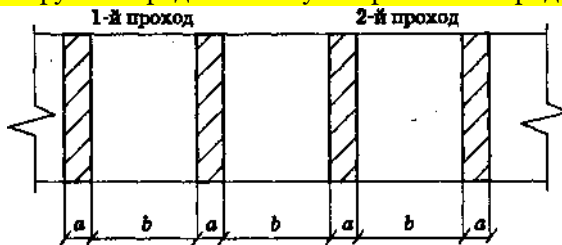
Схема для определения объемов работ при рыхлении мерзлого грунта баровой машиной
